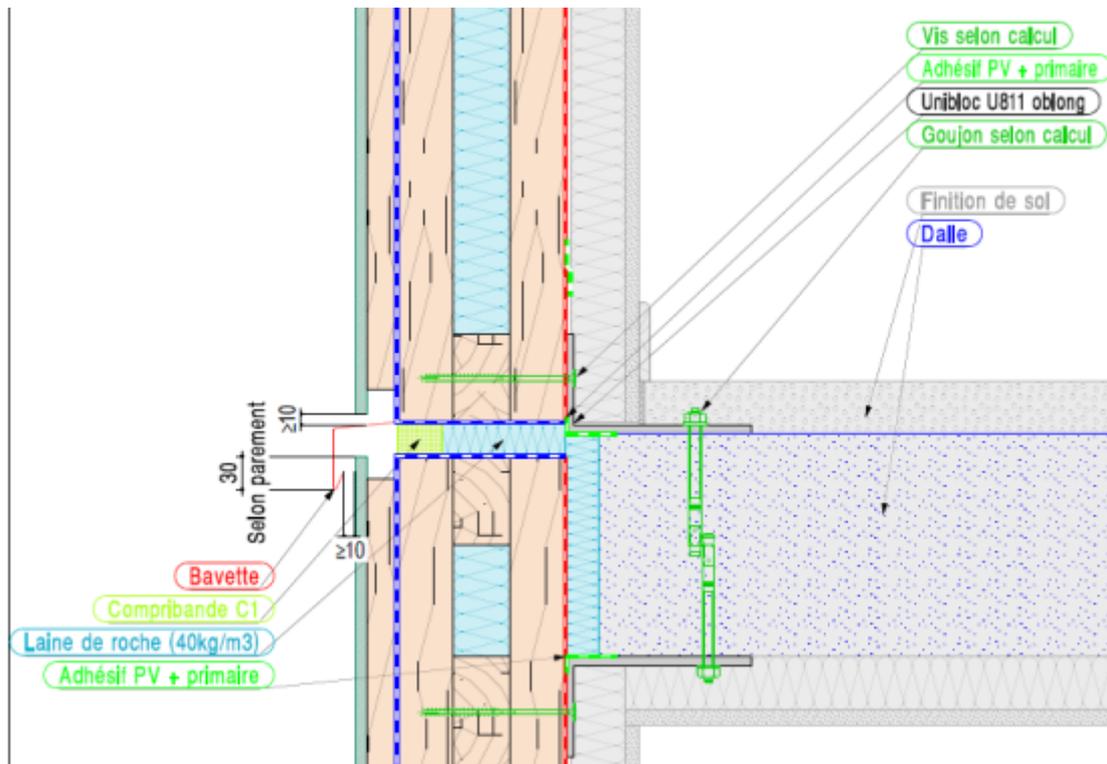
Pose du PANOBLOC® de refend à refend ou de poteau à poteau, avec parement extérieur ventilé / coupe verticale
